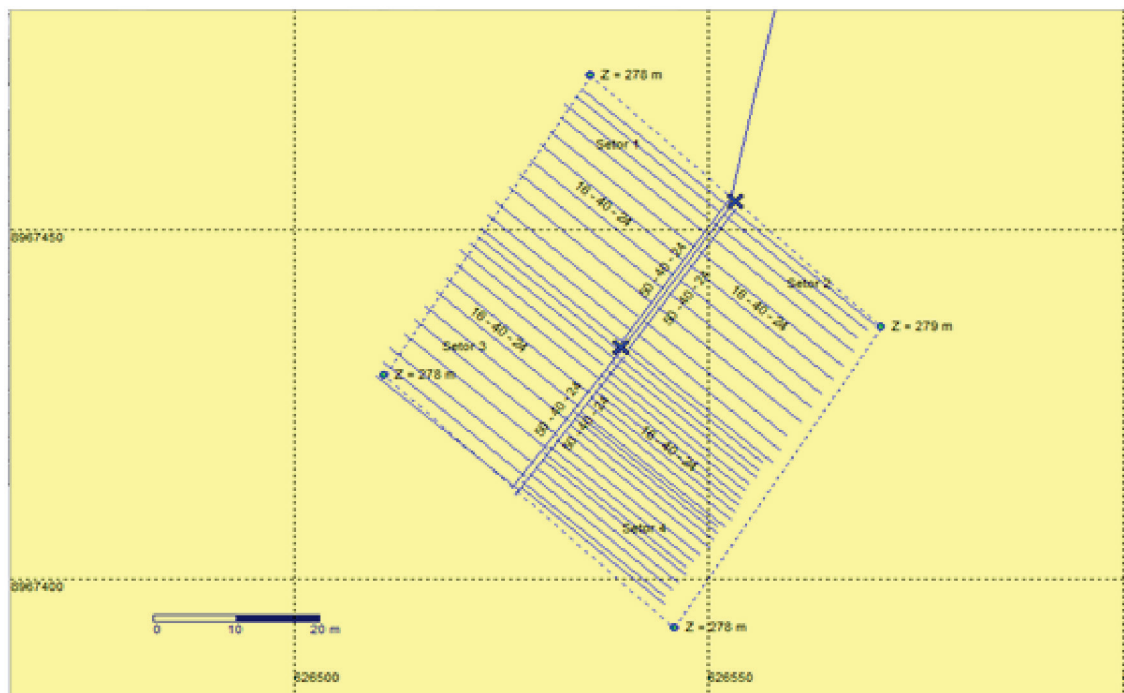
Área irrigada com setores de irrigação e dimensionamento de tubulações
